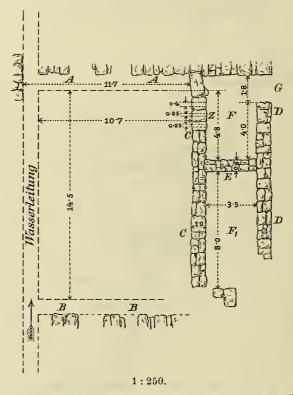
Grundriss der Mauerreste eines alten Schmelzofens in Čičevac.
